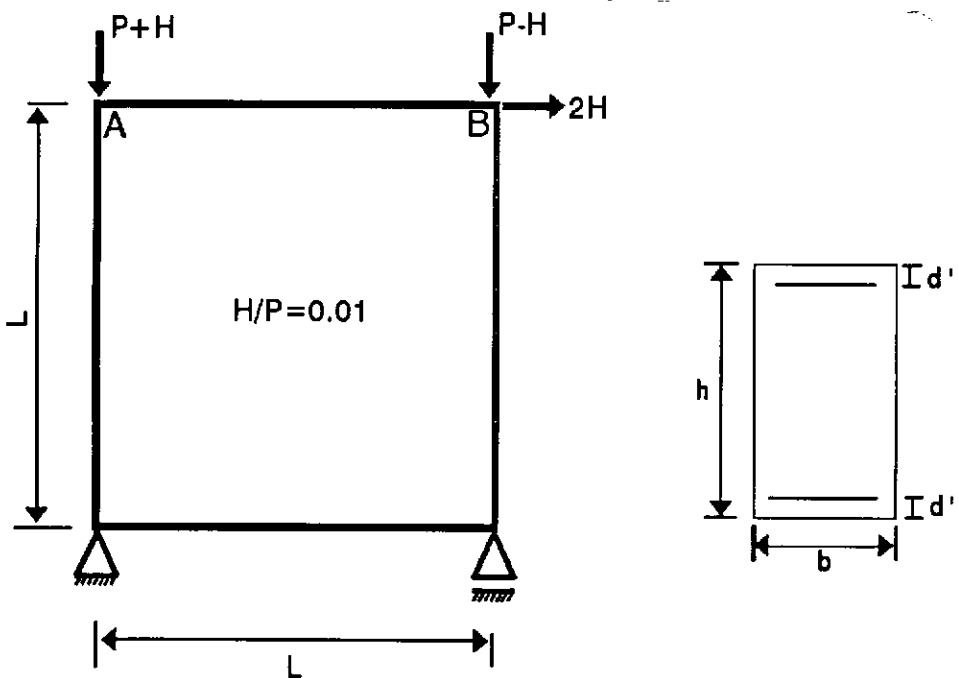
Geometria do pórtico de Fergusson e Breen
